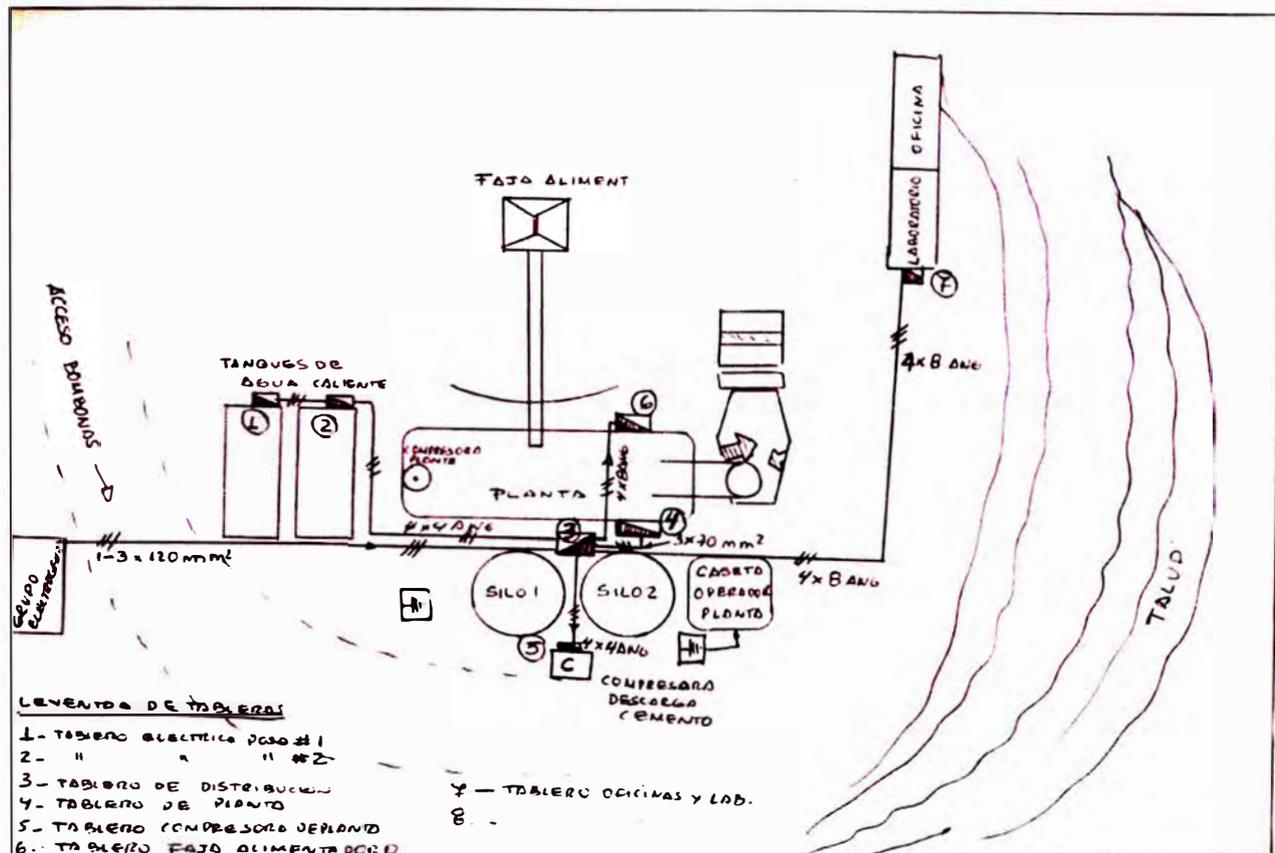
Esquema de distribución eléctrica para la planta de concreto. (Fuente: Oficina técnica de planta)
